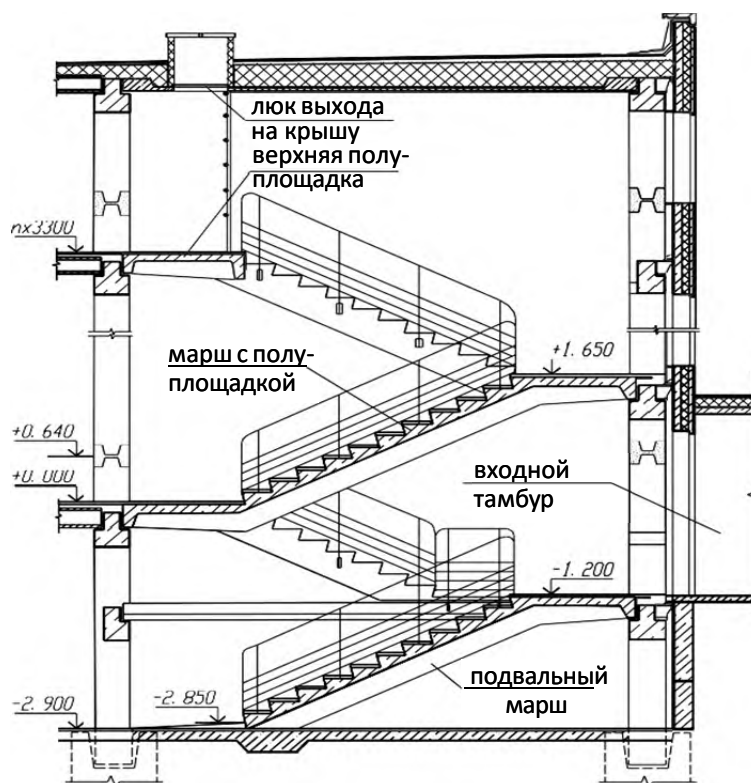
Деталь разреза каркасного здания по лестнице
